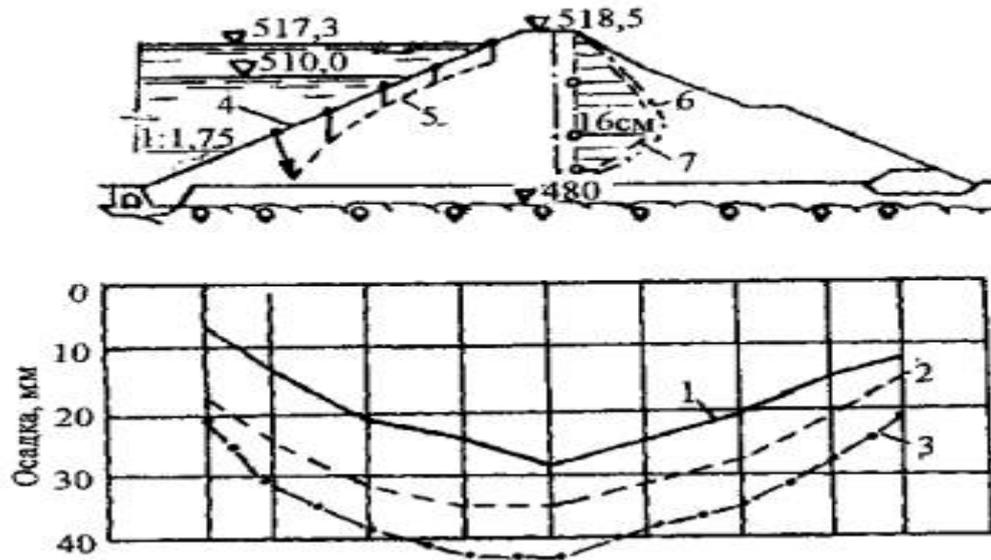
Эпюры осадки основания и смещений грунтовой плотины:
